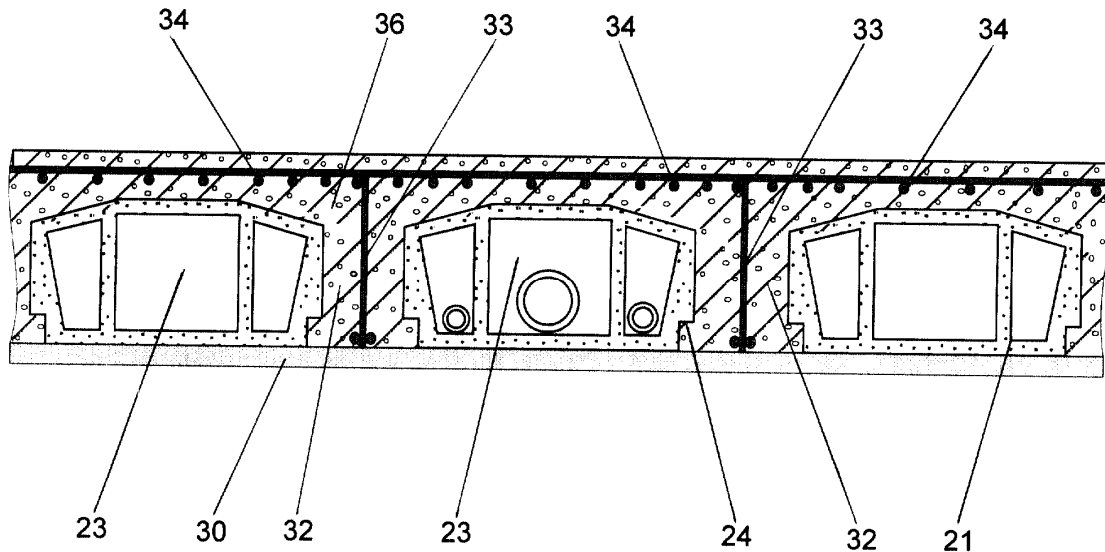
Сборно-монолитное перекрытие с пустотообразующими элементами, где: 21 – пустотообразующие элементы; 23 – пустоты; 24 – опорные полки; 30 – опалубка; 32 – каналы; 33 – арматурные каркасы; 34 – арматурные сетки; 36 – монолитная балка
